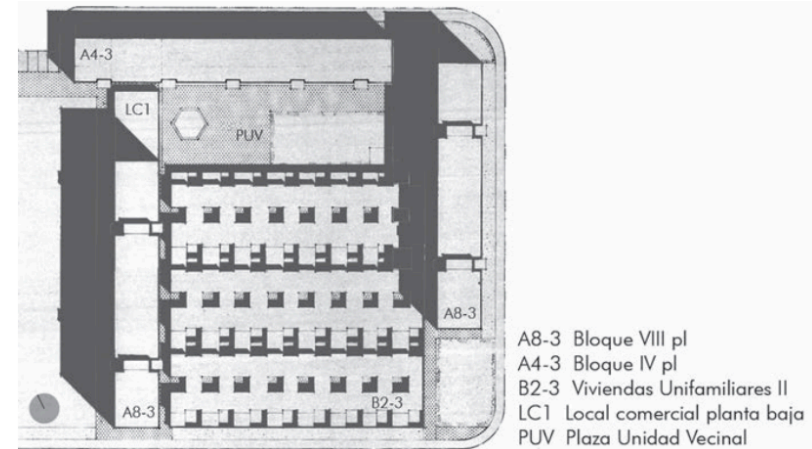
Planta de cubiertas de la unidad vecinal. *Hogar y Arquitectura. No 106 (1973)
